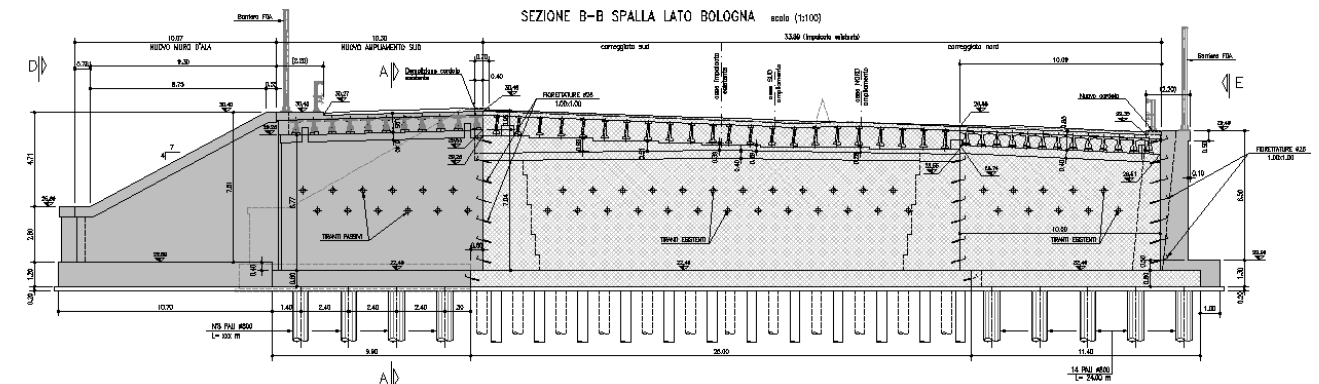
Prospetto della spalla lato Bologna
